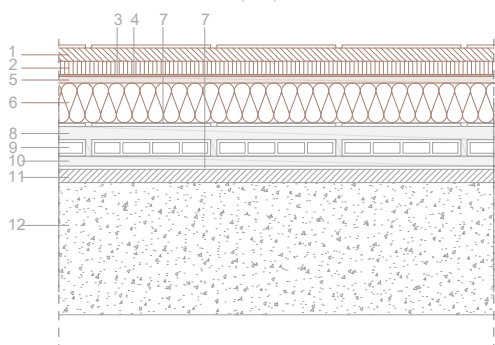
Detalle Cubierta tras la intervención.. Escala 1:10.
